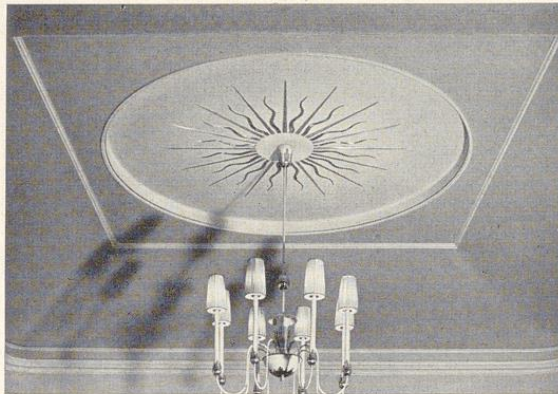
Profilierte Stuckdecke mit Deckenrosette
